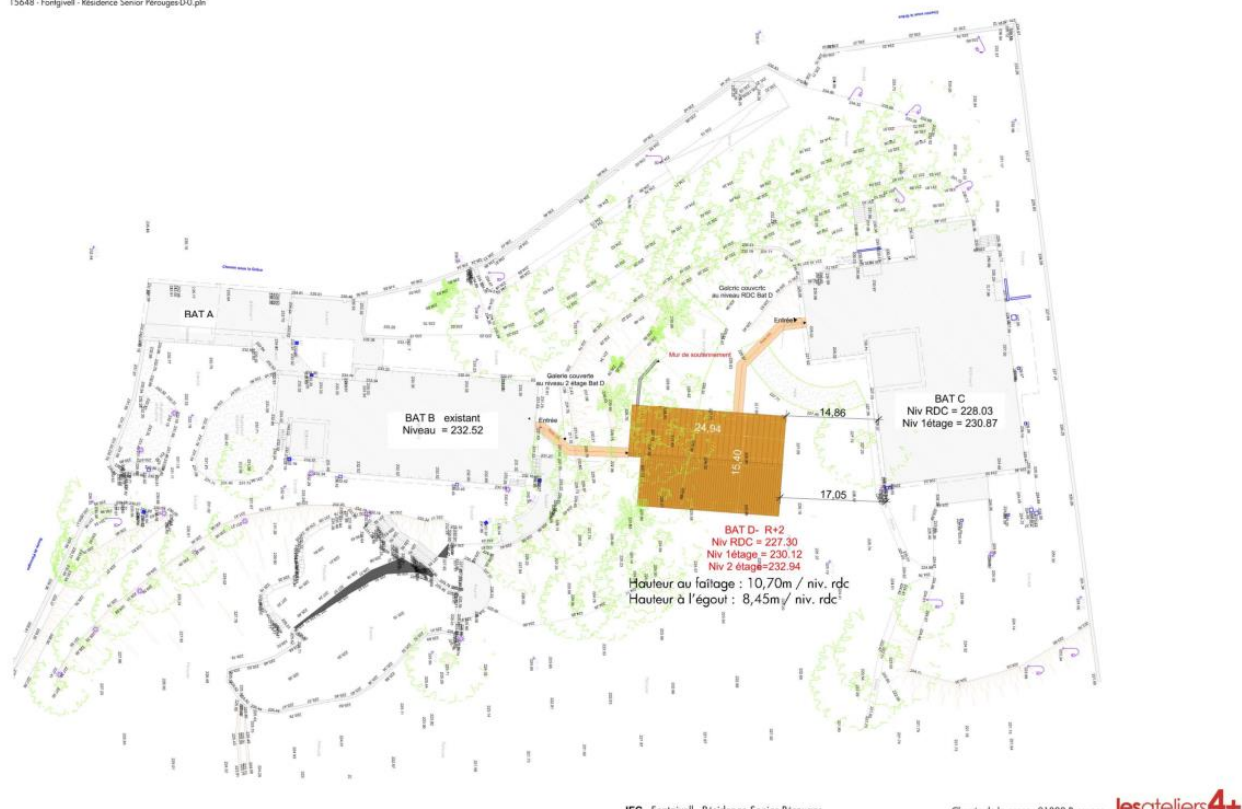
Plan masse du projet possible de réhabilitation (bâtiment A, B et C) et construction (bâtiment D). Source les Ateliers 4+
